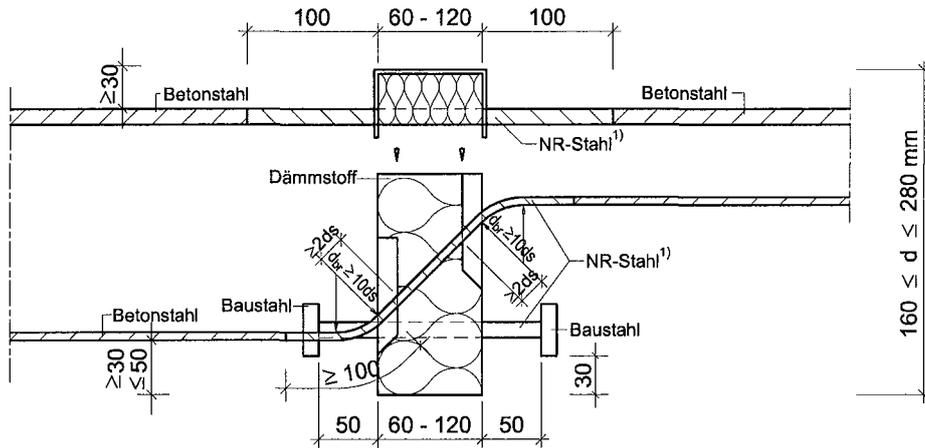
Schöck Isokorb Typ KF <sup>1)</sup>
